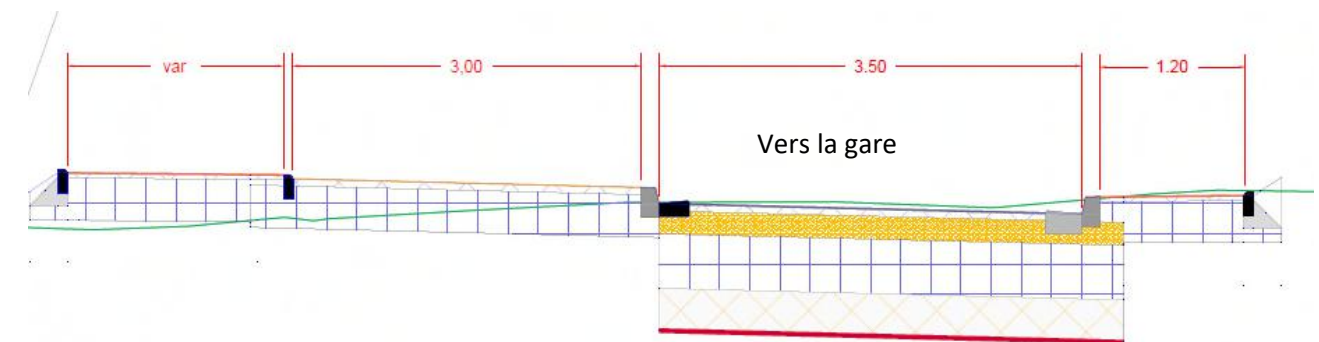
Coupe de chaussée type de la rue Guynemer (SNCF Réseau)
